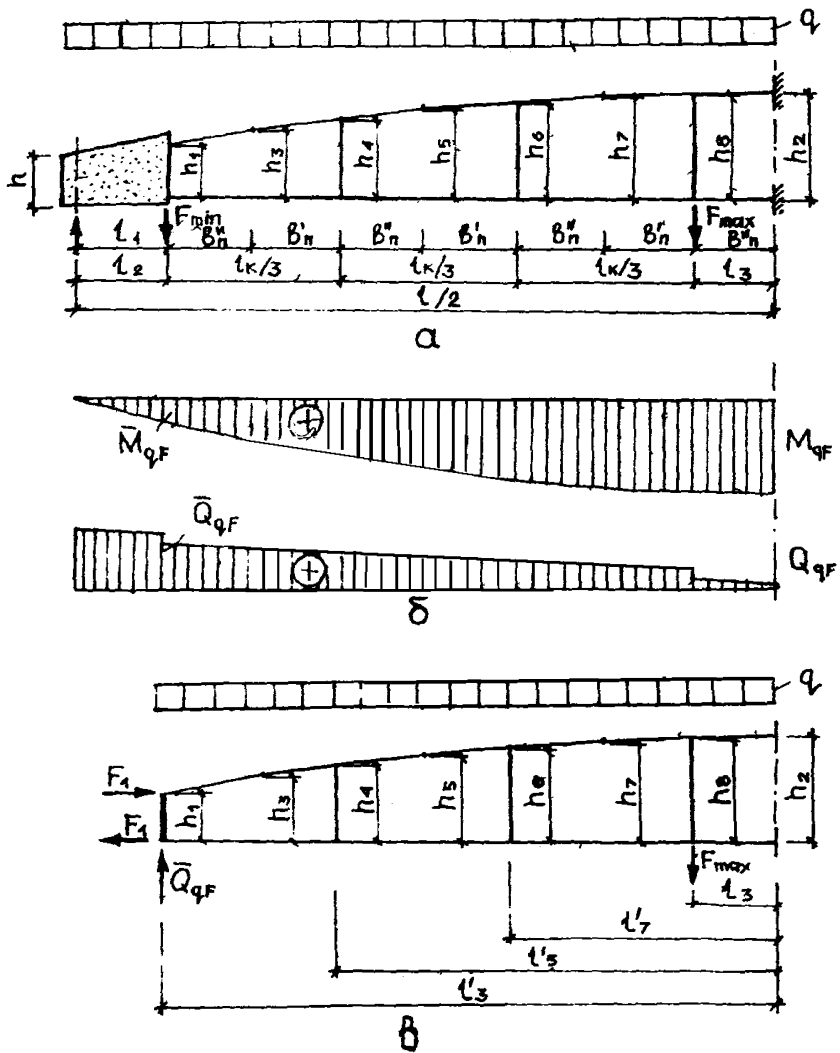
К построению расчетной схемы фермы диафрагмы по предельным состояниям второй группы
